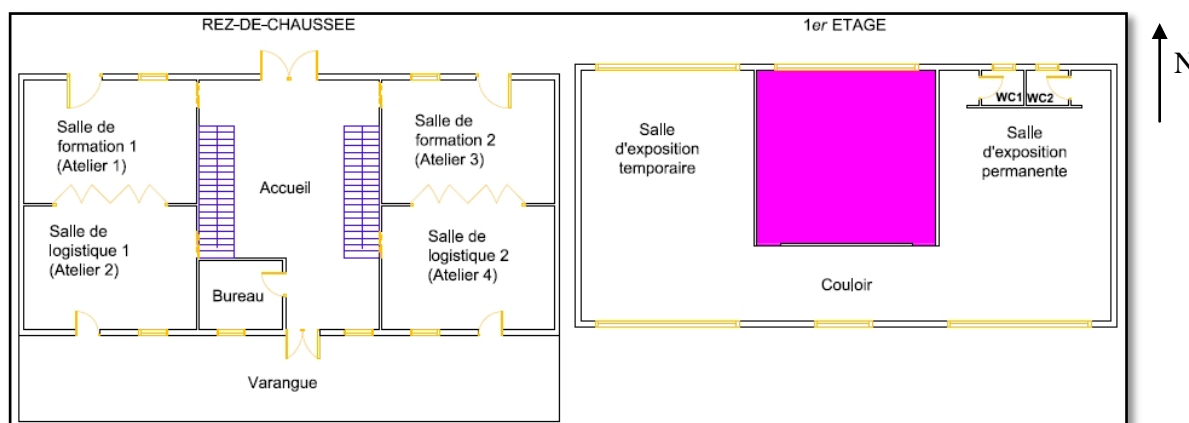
Plan 2D des bâtiments de l'espace bâti Artisanal
